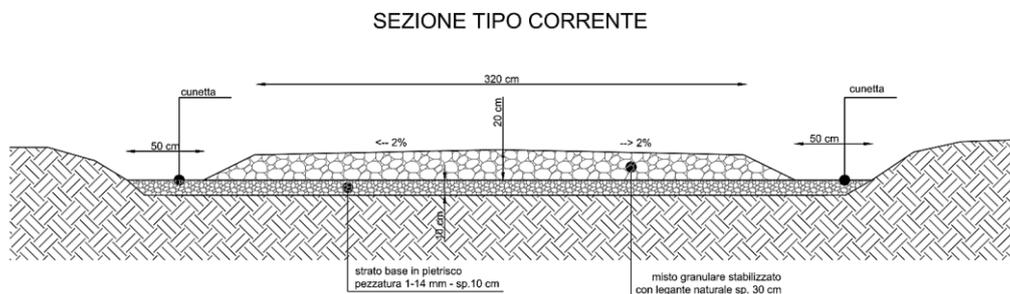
Sezione tipo strada di collegamento impianto/viabilità pubblica (Fonte: ns elaborazione)
